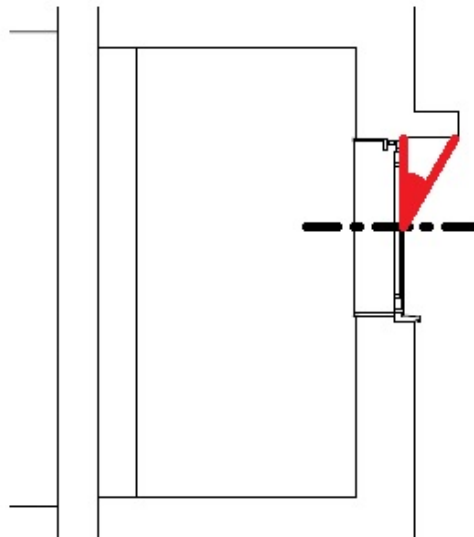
Pormenor janela cozinha (elemento horizontal)
